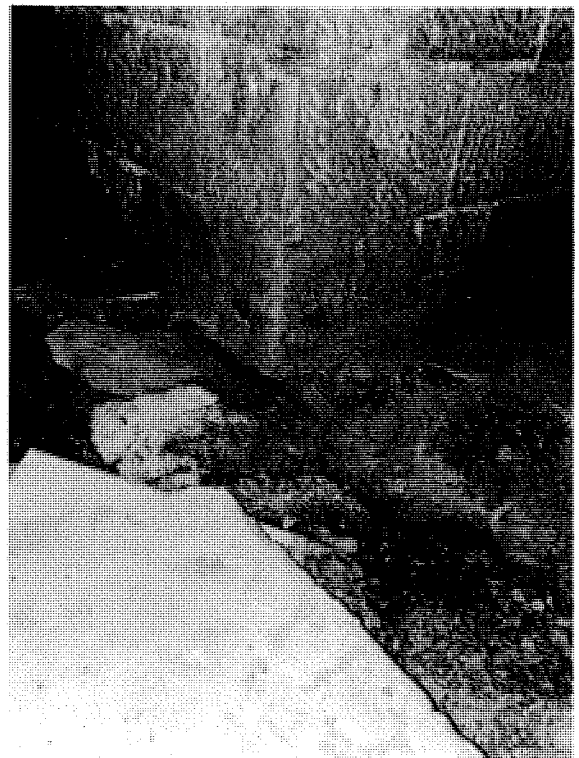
Intersecții ziduri beci – deteriorări pardoseală afectată de staționarea apei din infiltrații
